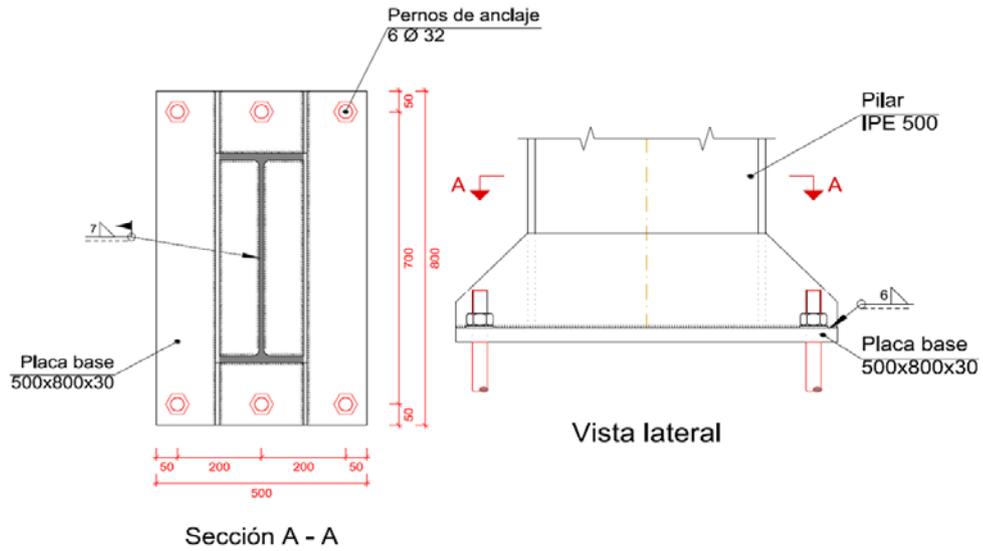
Placa de anclaje tipo 2 (fachada lateral).
